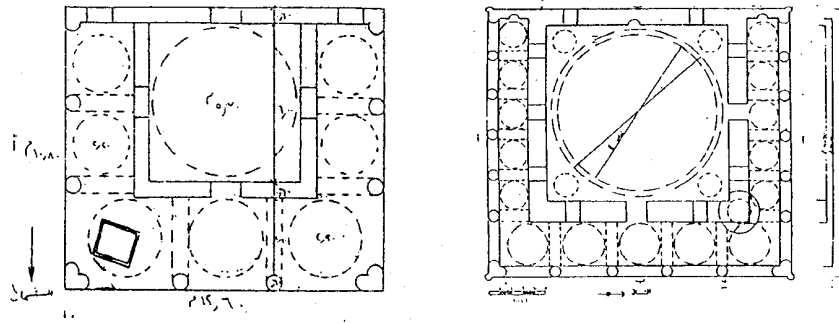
مسقط أفقى لمشهد كلثوم
